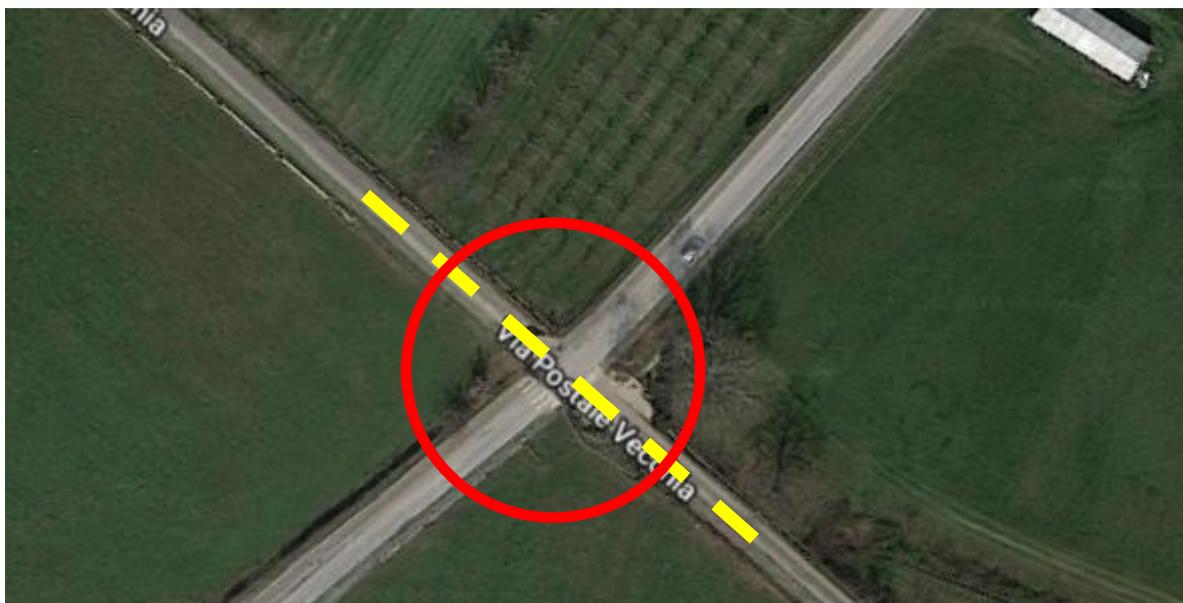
Foto aerea dell'intersezione oggetto di intervento
